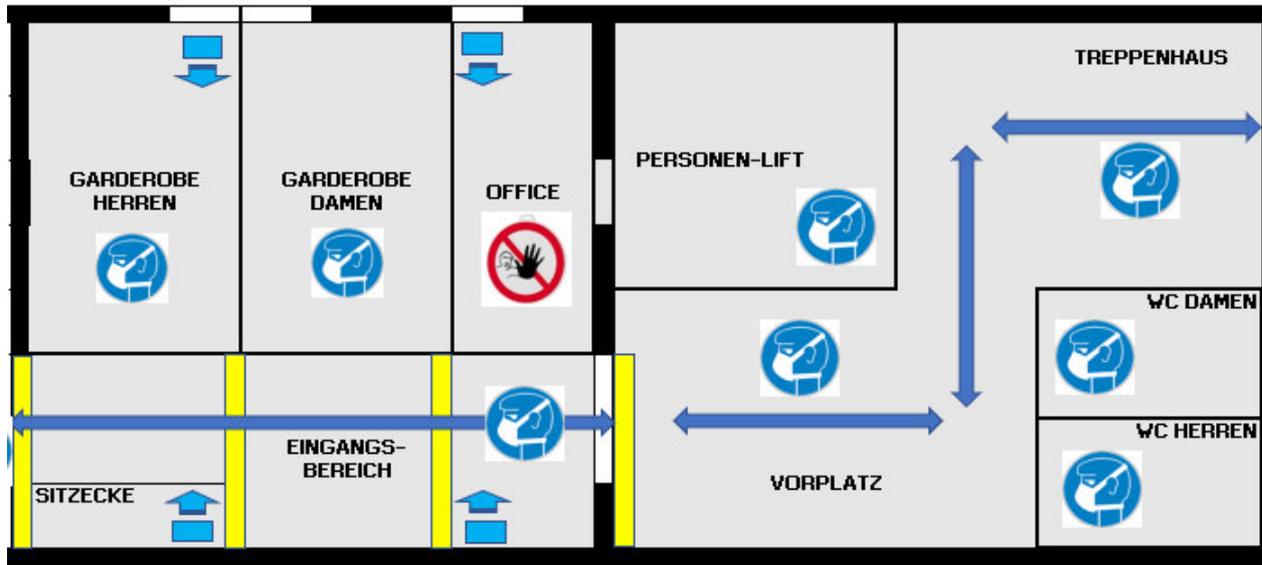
Grundriss Eingangsbereich Dojo Illnau
